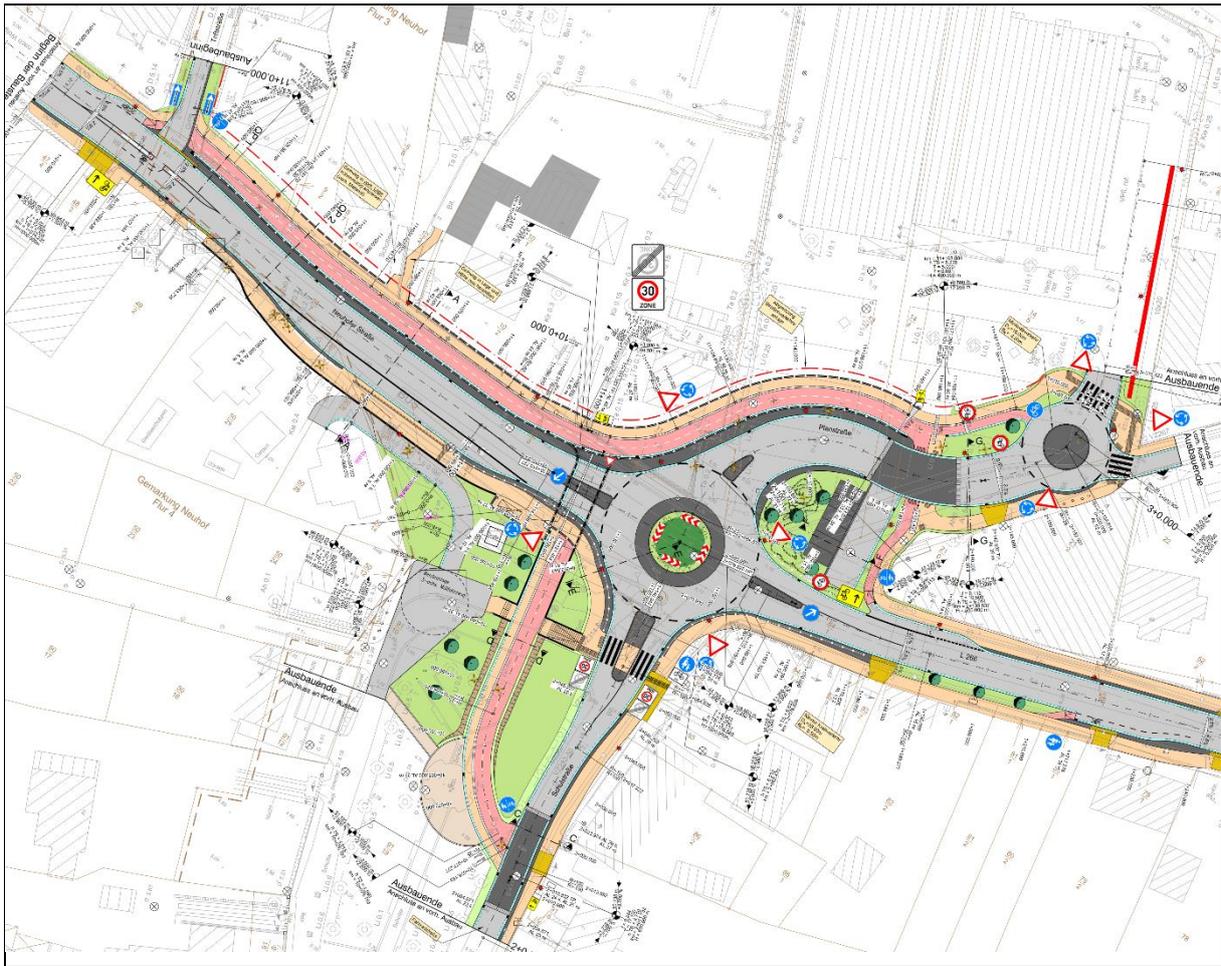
Straßenplanung für das Plangenehmigungsverfahren
